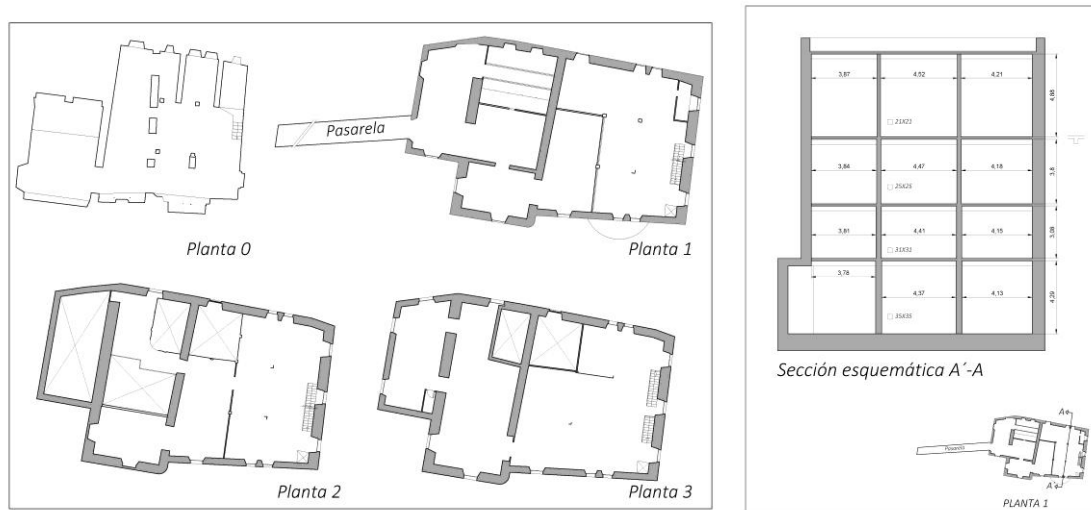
plantas y alzado de la fábrica en la actualidad. Levantamiento realizado por los autores.
